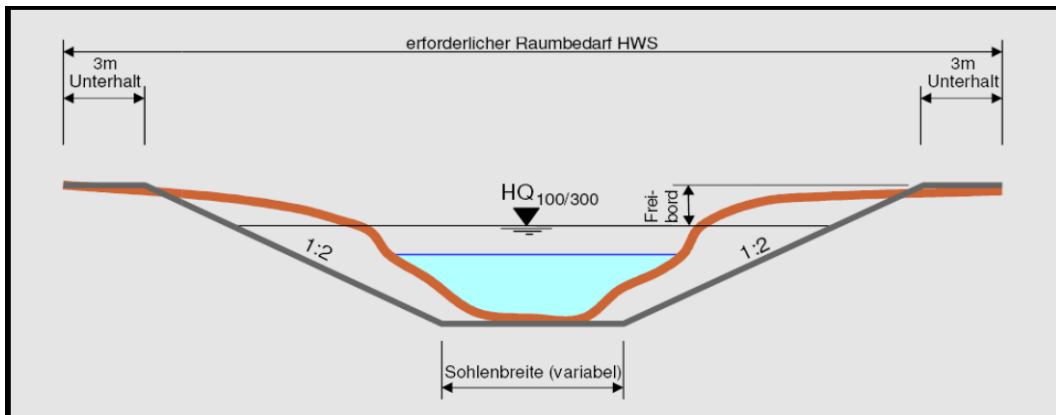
Querprofilbetrachtung für offene Oberflächengewässer [3]
